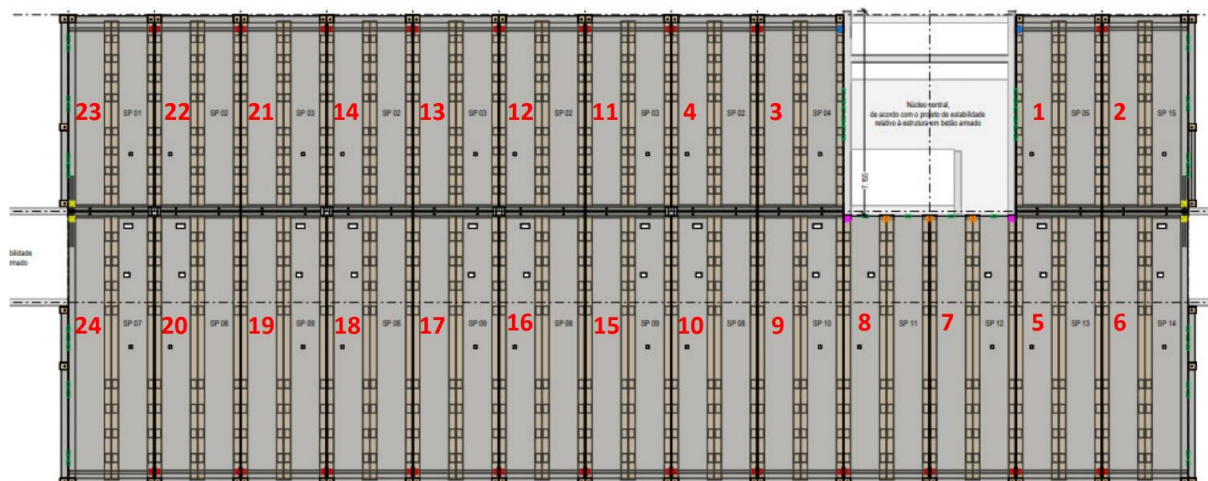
Sequência da montagem dos painéis de laje (sem escala)
